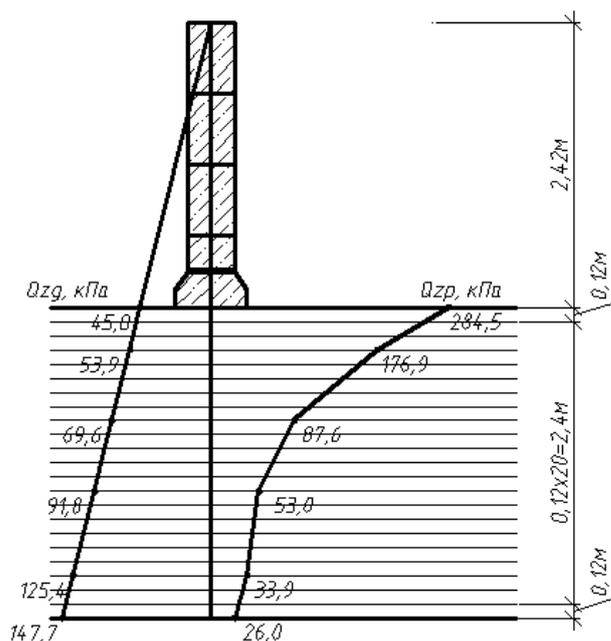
Схема к расчету осадки фундамента под внешние стены после реконструкции.
